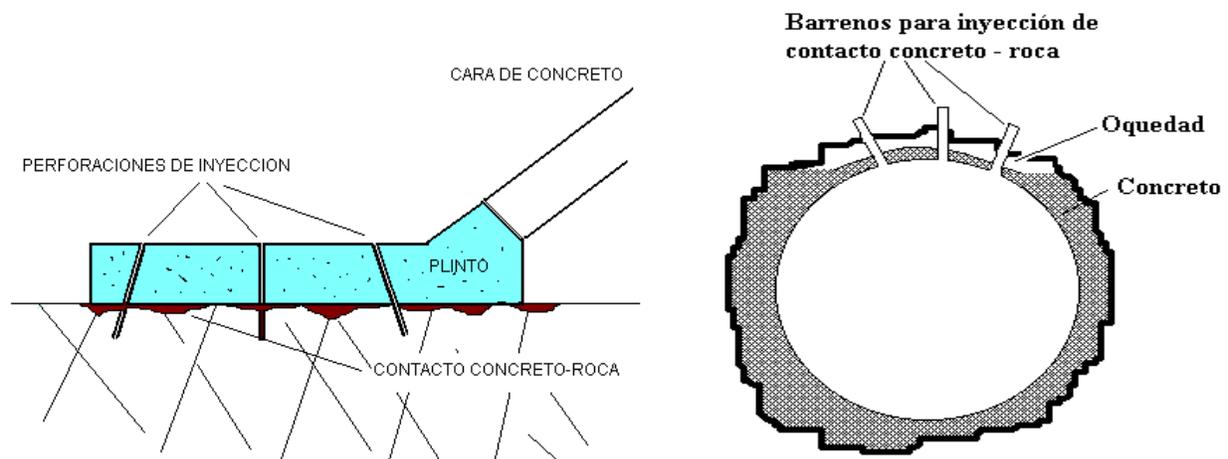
a Inyección de consolidación en plinto    Figura II.1.9.2.1.b Inyección de contacto en galerías
